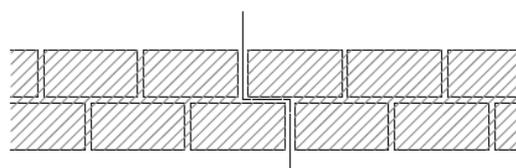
Junta de movimiento con solape. Esquema en planta
